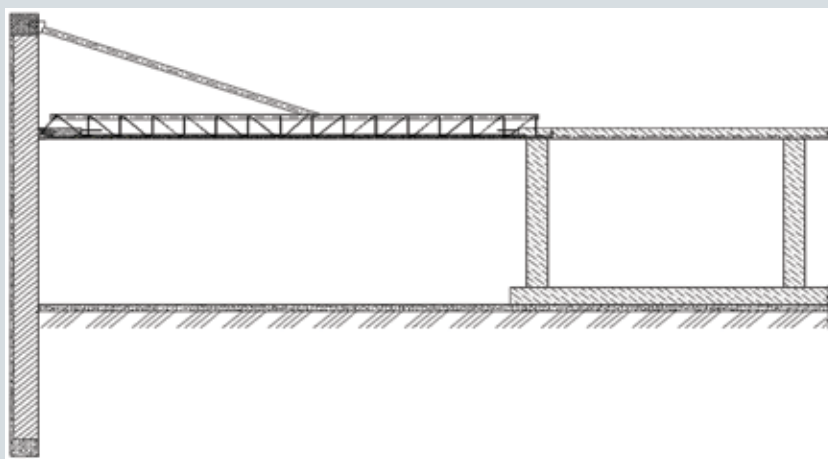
Технология крепления широкого котлована сталежелезобетонными большепролетными распорками, включаемыми в состав перекрытия
